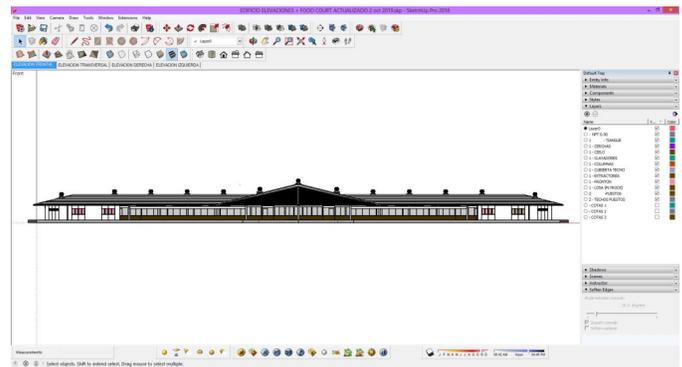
Vista 2D Skecht Up - Edificio Tiangué
